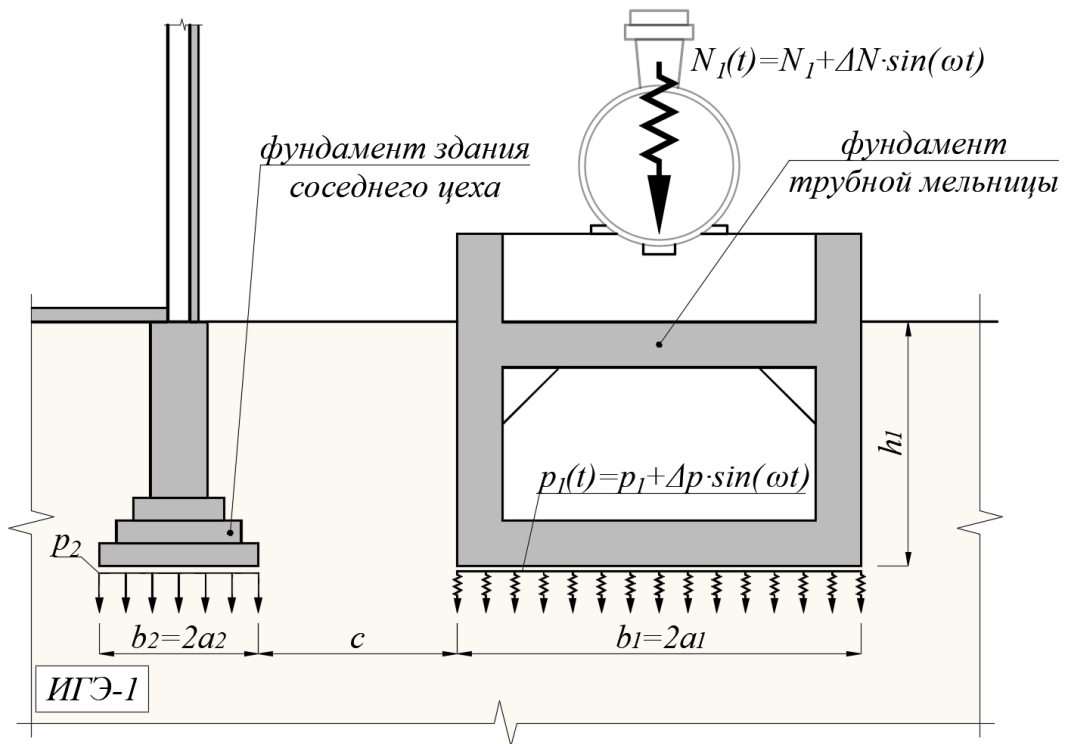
Схема основания фундамента трубной мельницы, являющегося источником динамического воздействия, и фундамента здания соседнего цеха [265]
